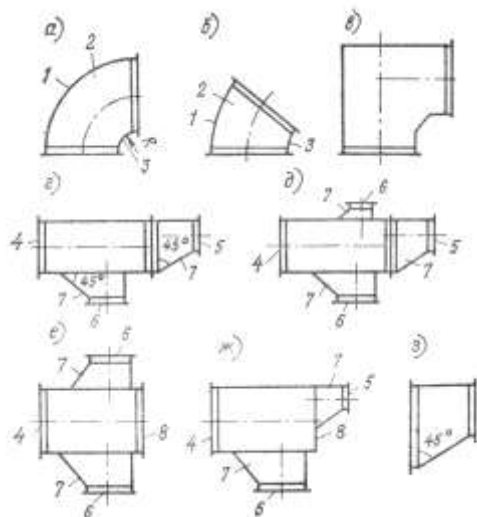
Фасонные части прямоугольных воздуховодов.
